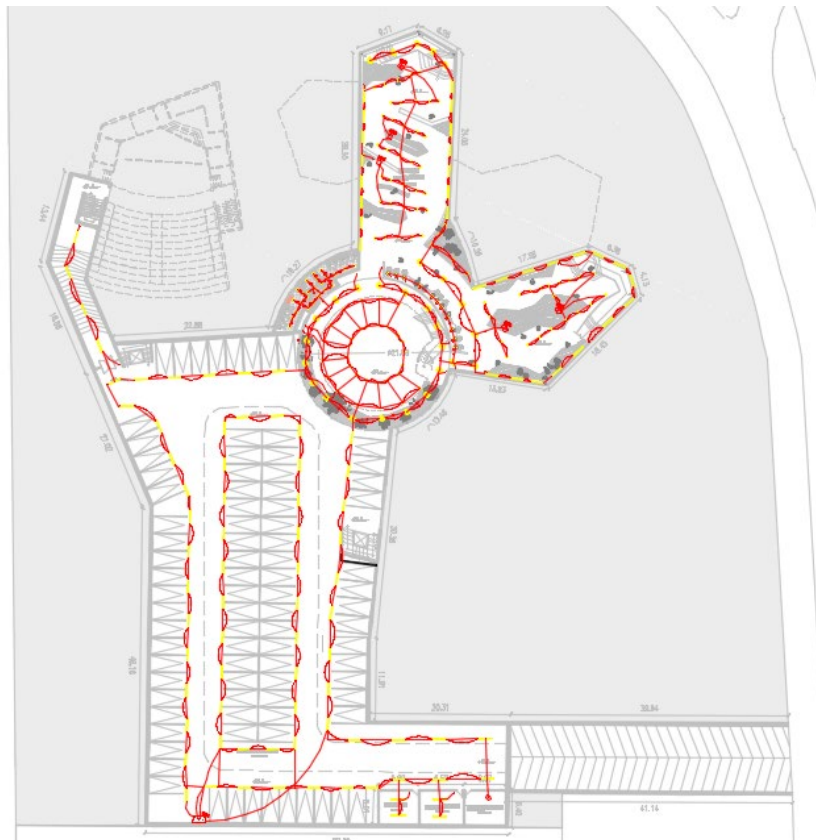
Plano de instalaciones eléctricas planta cuarto nivel.
